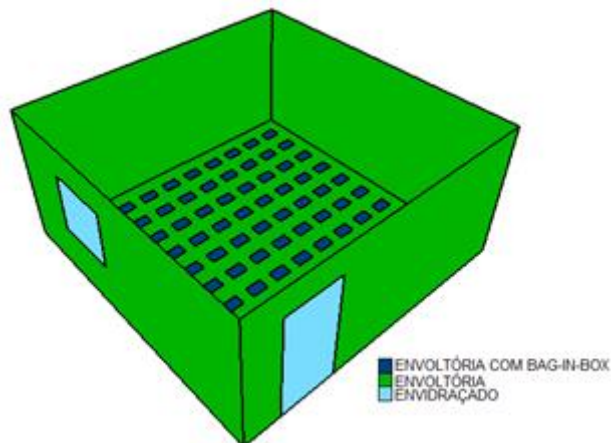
Exemplo ilustrativo das Bag-in-Box® no pavimento
